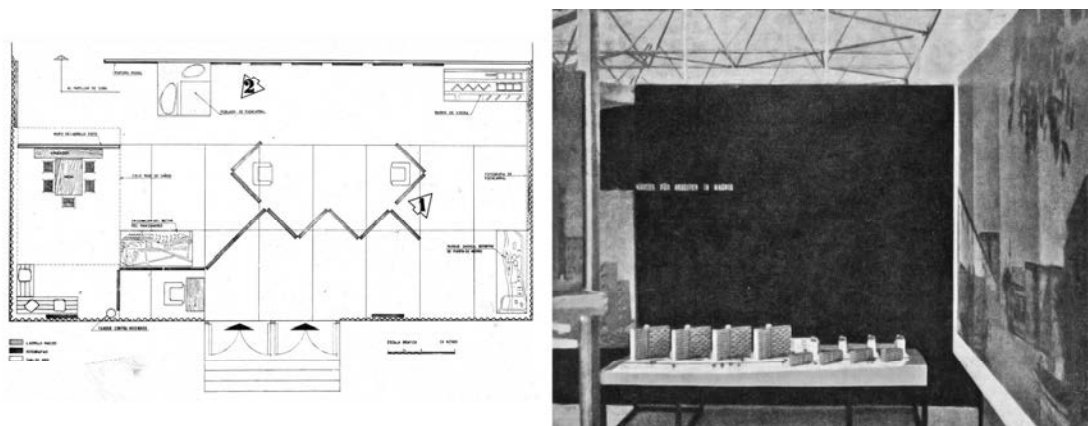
Planta e interior del pabellón de la OSH en la "Interbau" de Berlín, Hogar y Arquitectura, 1957.
